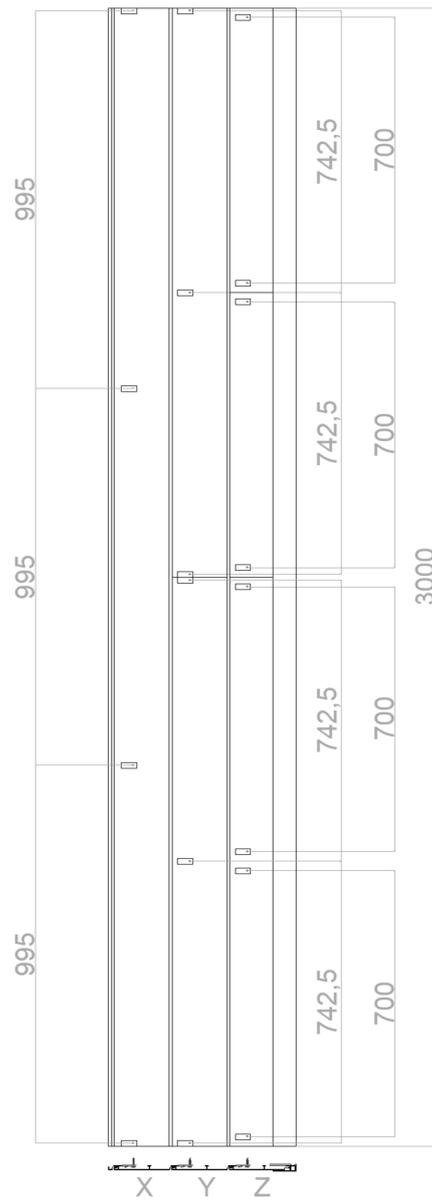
Prospetto e sezione del campione sottoposto a prova_Cladding 150
